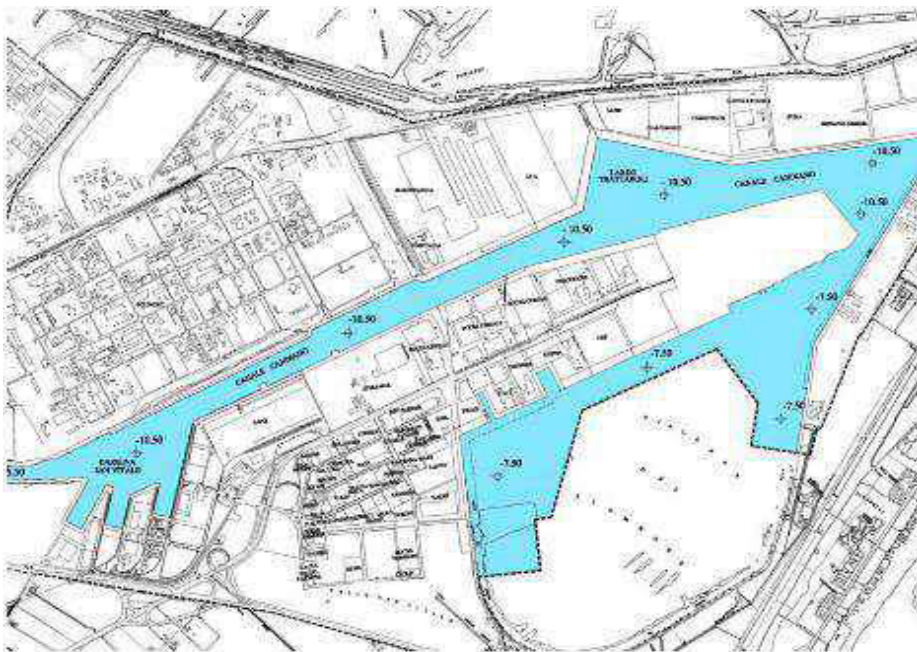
Planimetria Porto di Ravenna 2/3 (Pialassa del Piombone, il Largo Trattaroli, la continuazione del Canale Candiano fino alla Darsena San Vitale) - Fonte: PRP – AdSP
